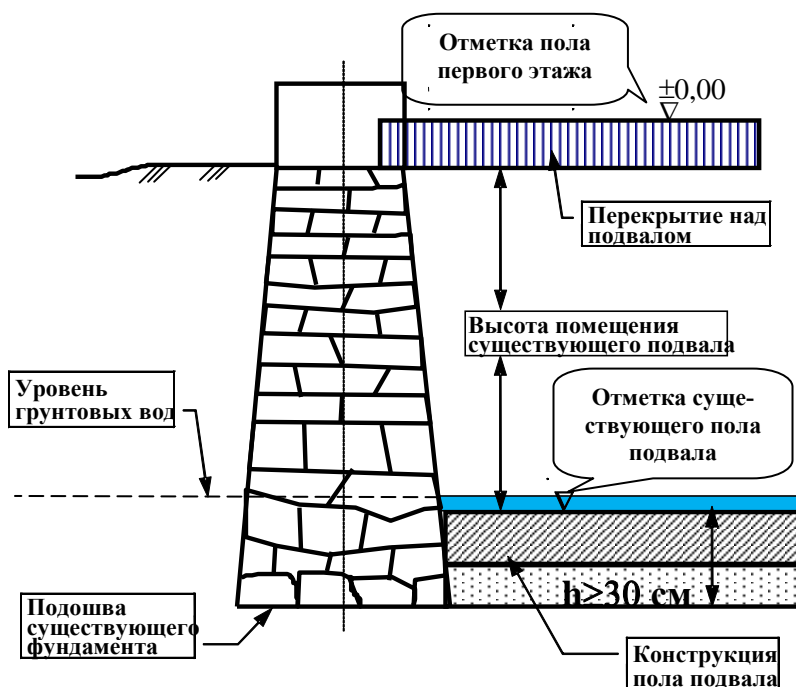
Типичный конструктивный разрез фундамента с подвальным помещением и разрушенной гидроизоляцией при высоком уровне грунтовых вод (У.Г.В.)
